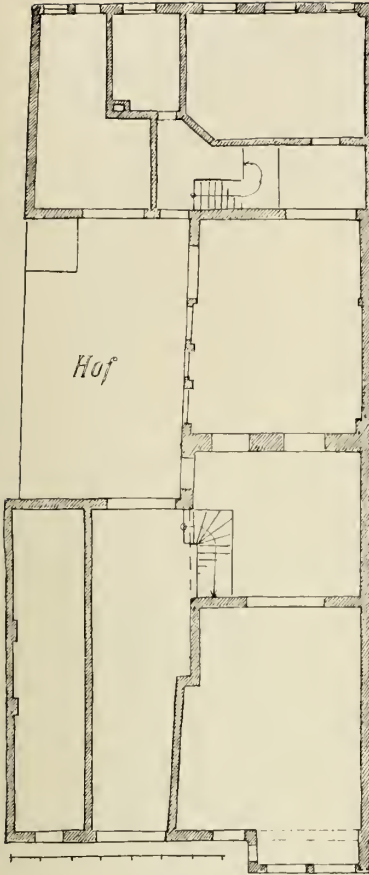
Hannover; Burgstraße 28, Grundriß.
